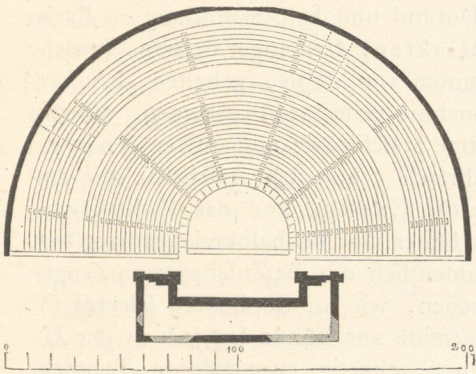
Theater zu Segesta (Grundriss).
